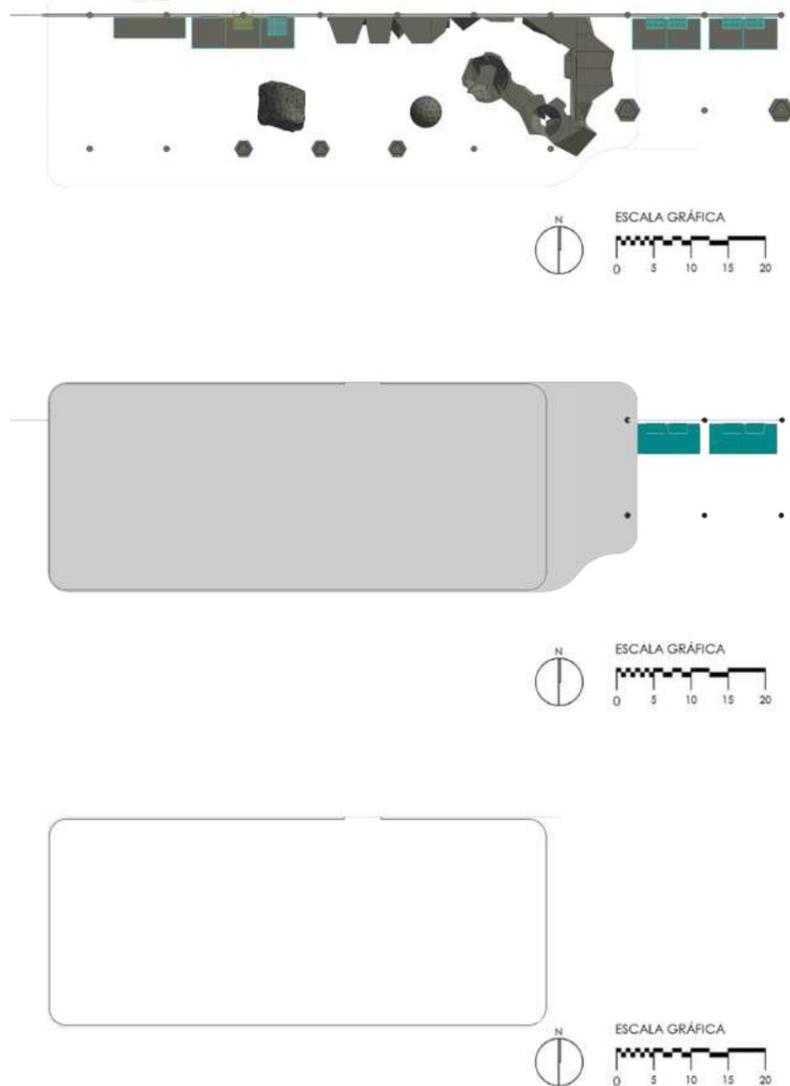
, 112 e 113: Planta Baixa do Térreo, Mirante e Coberta do Bloco de Escalada.
